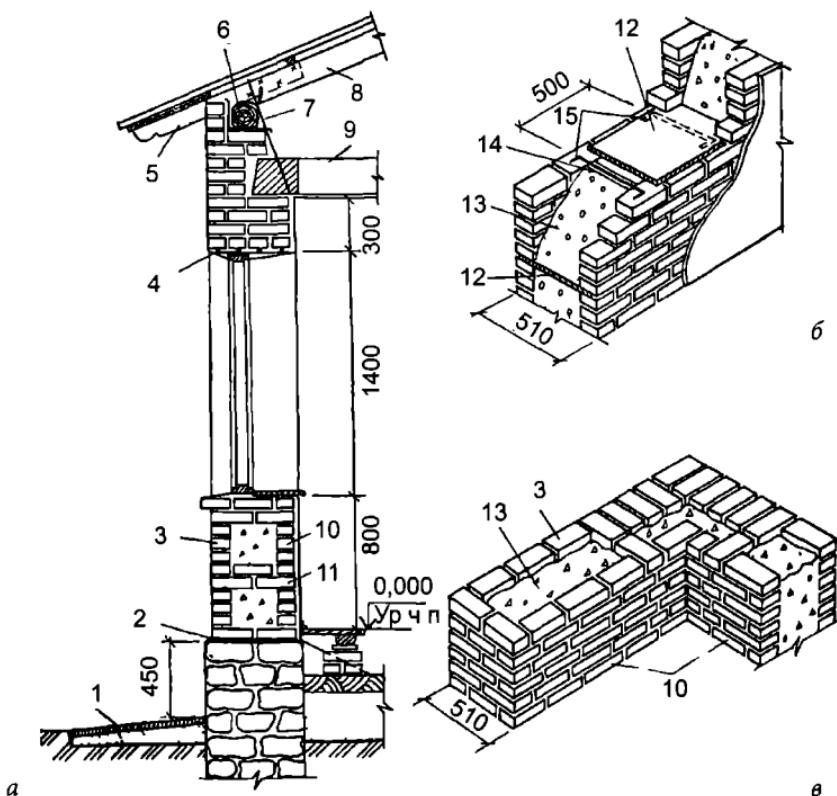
Конструкция стены из облегченной кирпичной кладки:
